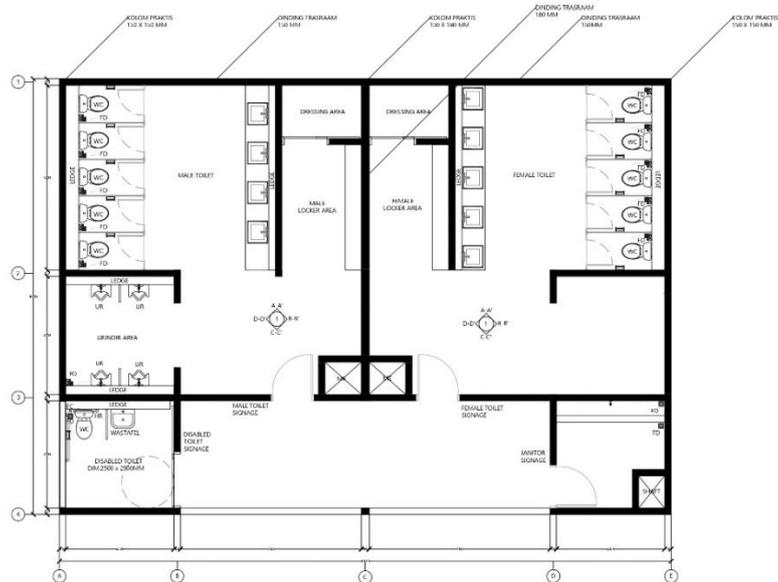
Gambar 2D Denah Detail Timur Tangga Kebakaran
